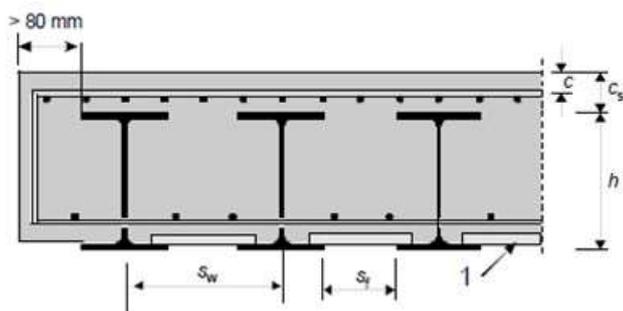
Section-type d'un tablier à poutres enrobées
